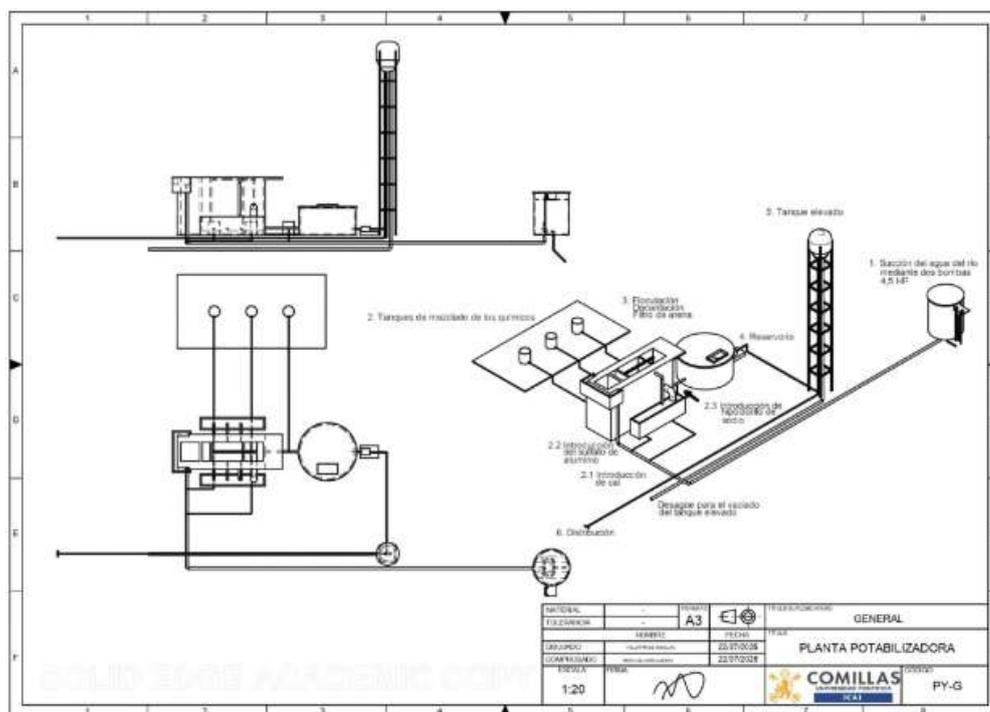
Vista general de la planta con alzado, planta y miniatura 3D con explicación
